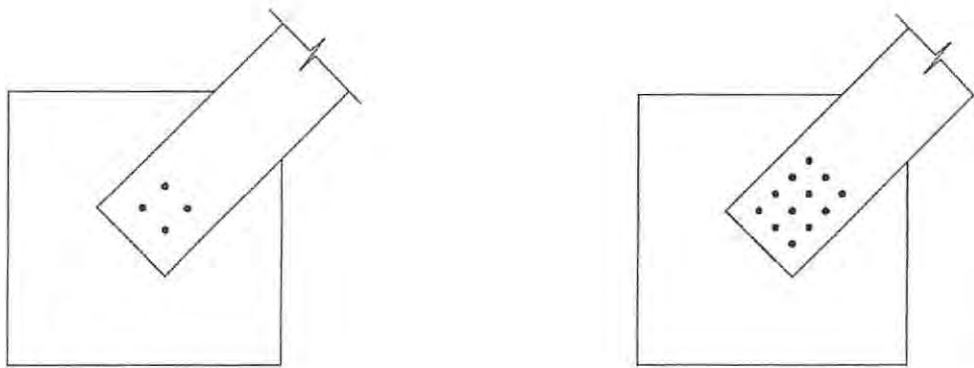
Conexiones gusset sistema mixto y sistema arriostrado con pletinas
